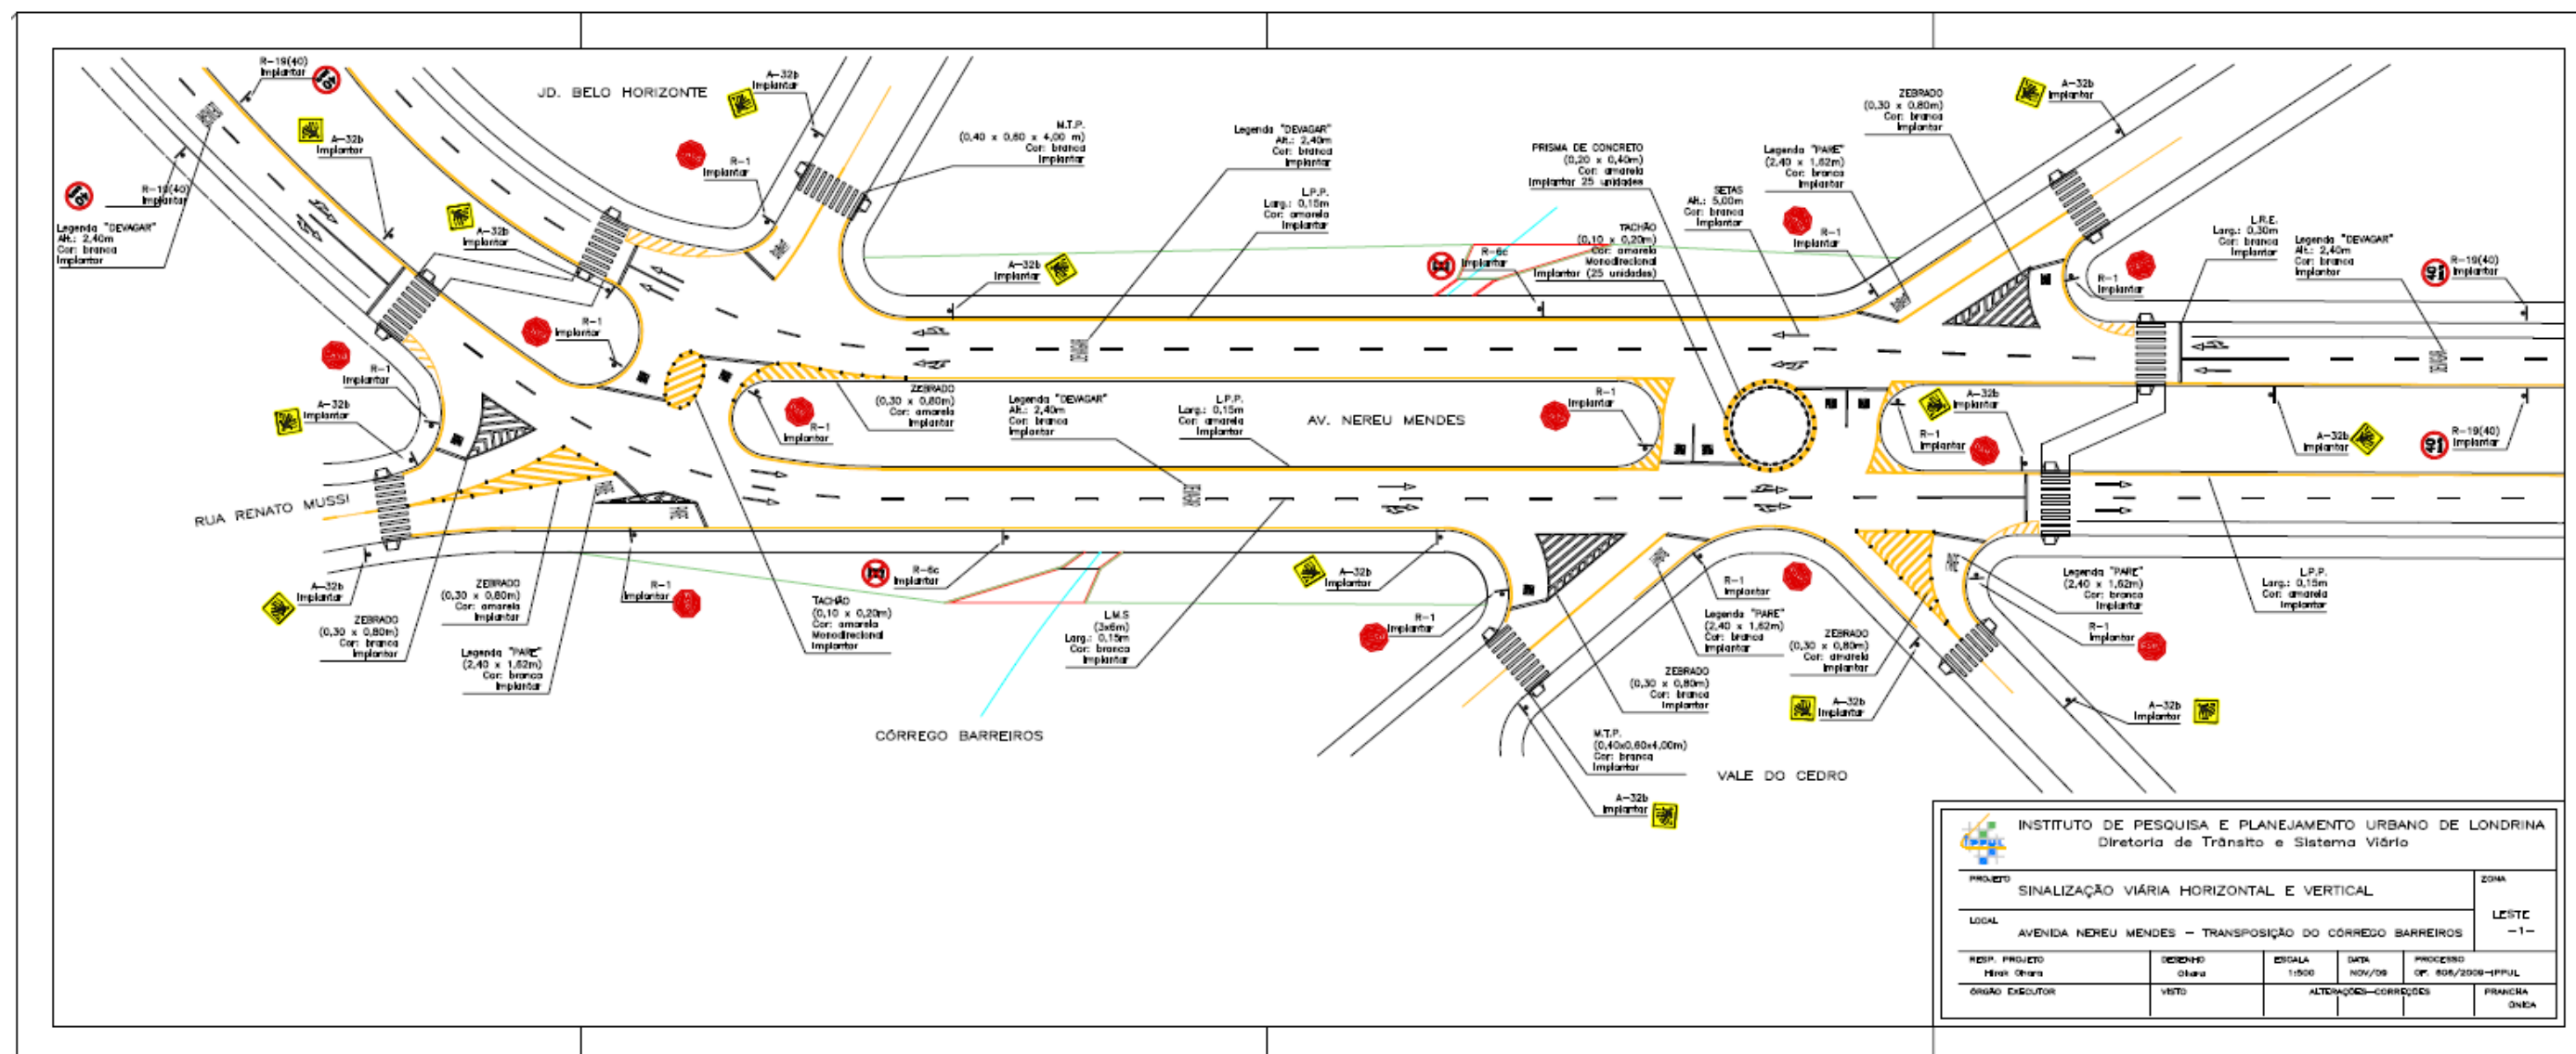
Projeto de sinalização viária horizontal e vertical da transposição do Córrego Barreiro.
